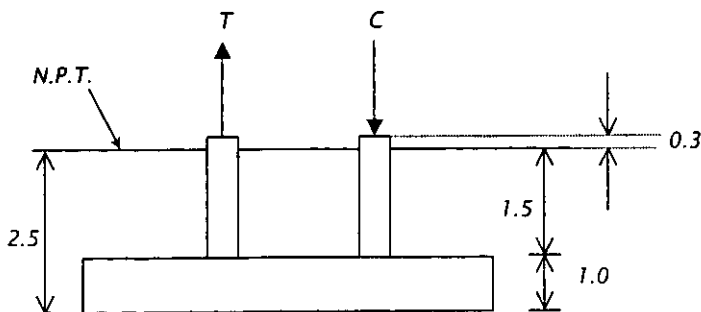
10. Losa en elevación (Unidades en metros).
